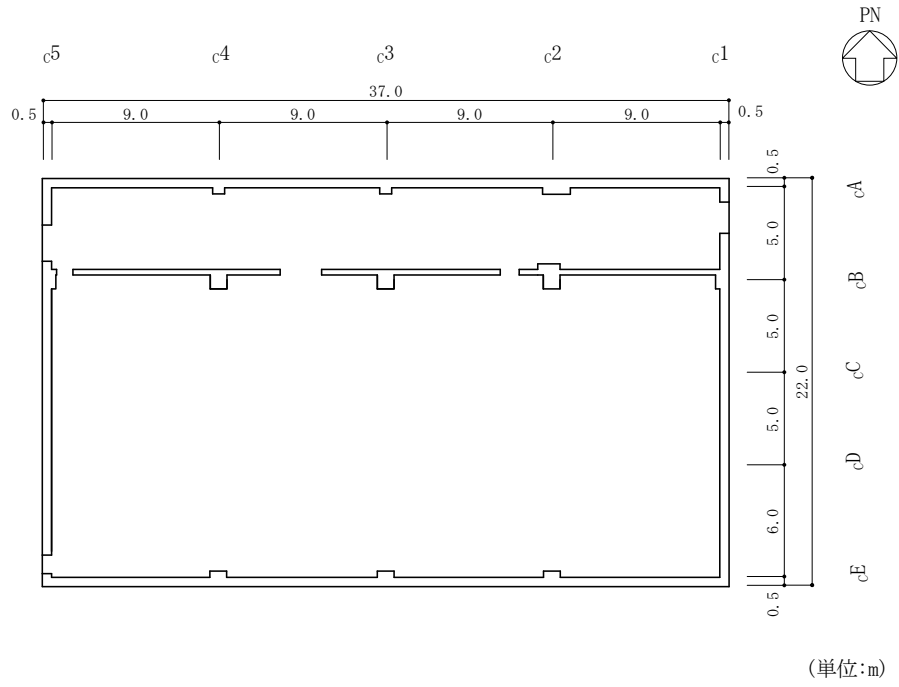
(1) 制御室建物の概略平面図 (4F, EL 16.9m)
